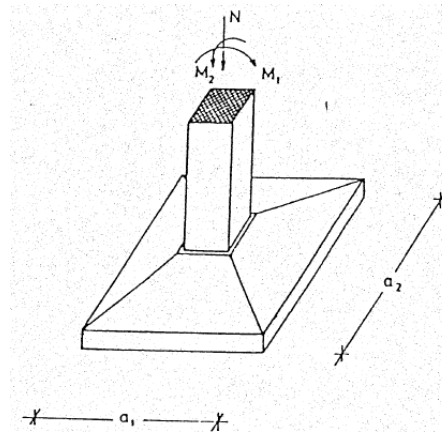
Diagrama de solicitaciones de las zapatas aisladas
